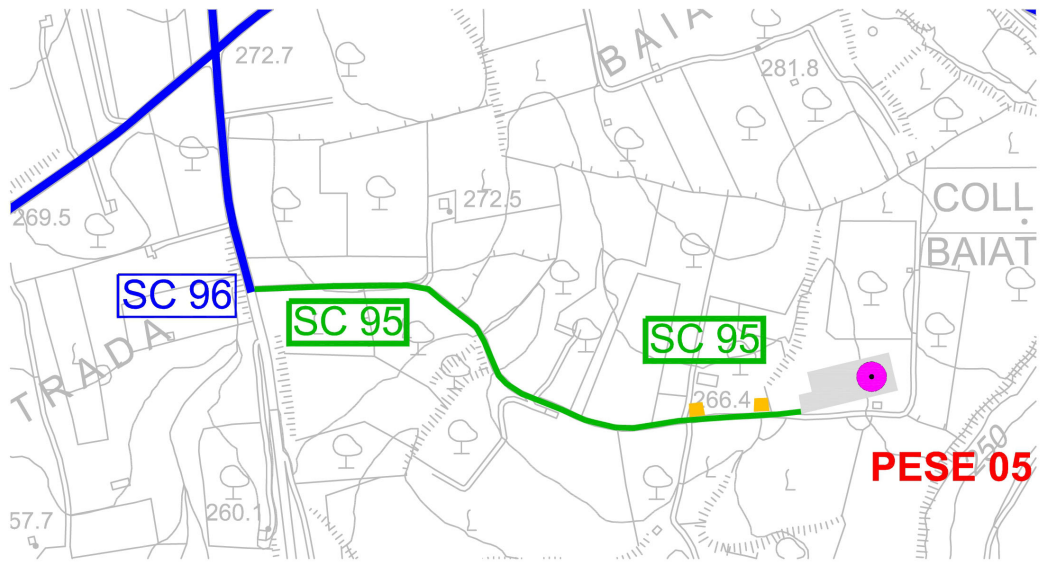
Planimetria delle strade di cantiere scala 1:5.000
